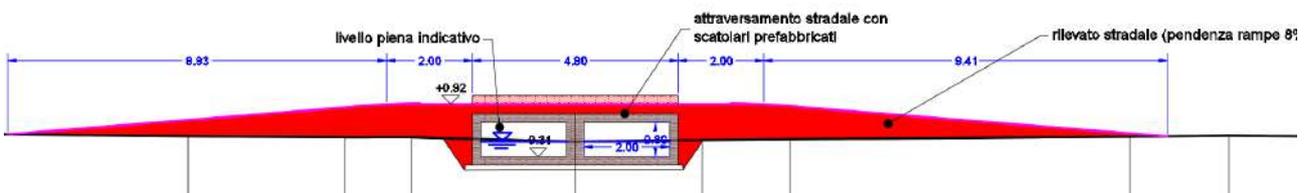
Sezione tipo attraversamento scolmatore. (rappresentazione non in scala)
